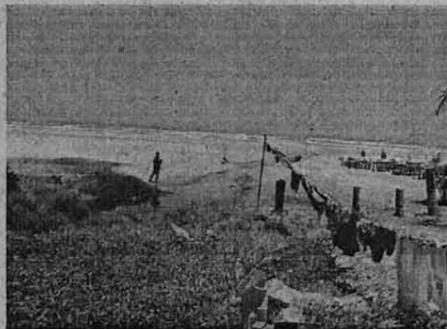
Última drenagem vistoriada, no ponto 013. Bar adjacente, à direita da foto.
